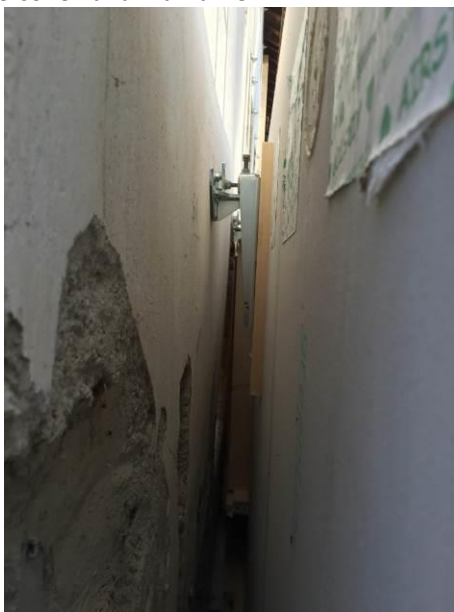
Montage und Einrasten des E.T.-Fassadensystemverbinders
